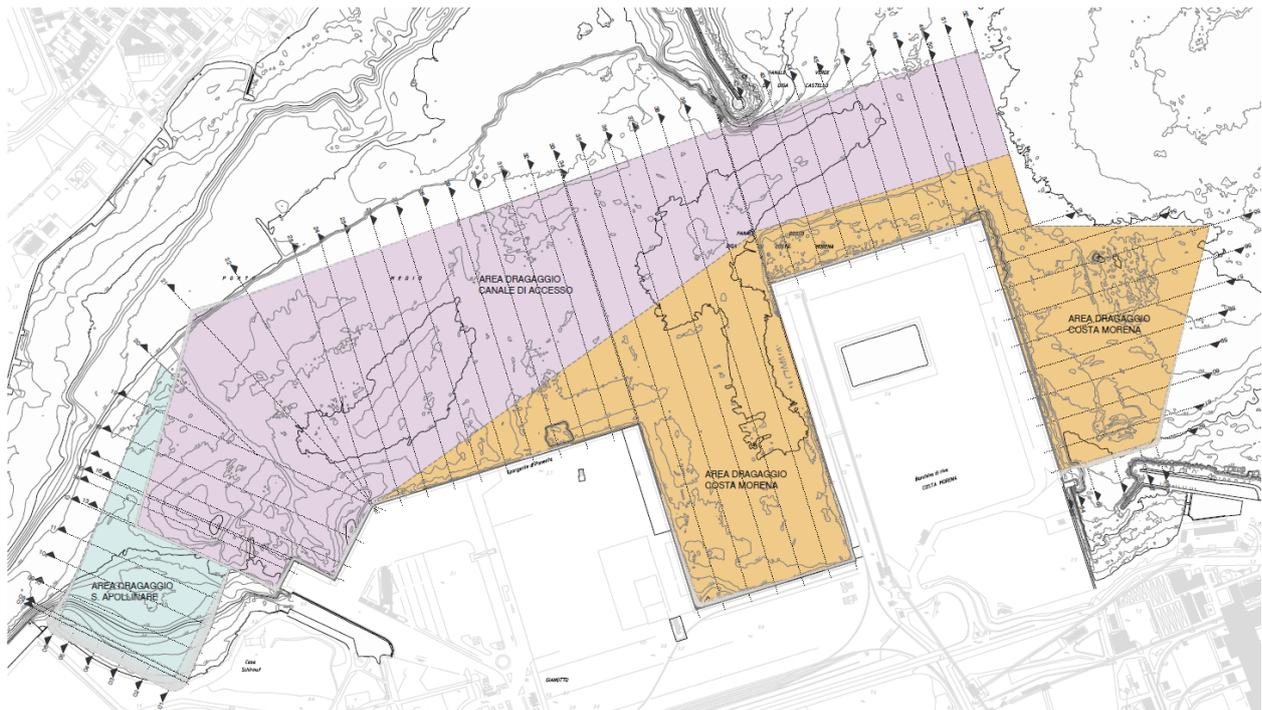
Stralcio della planimetria generale di dragaggio (Cfr. 09-017-DT-202-0-PLA)
